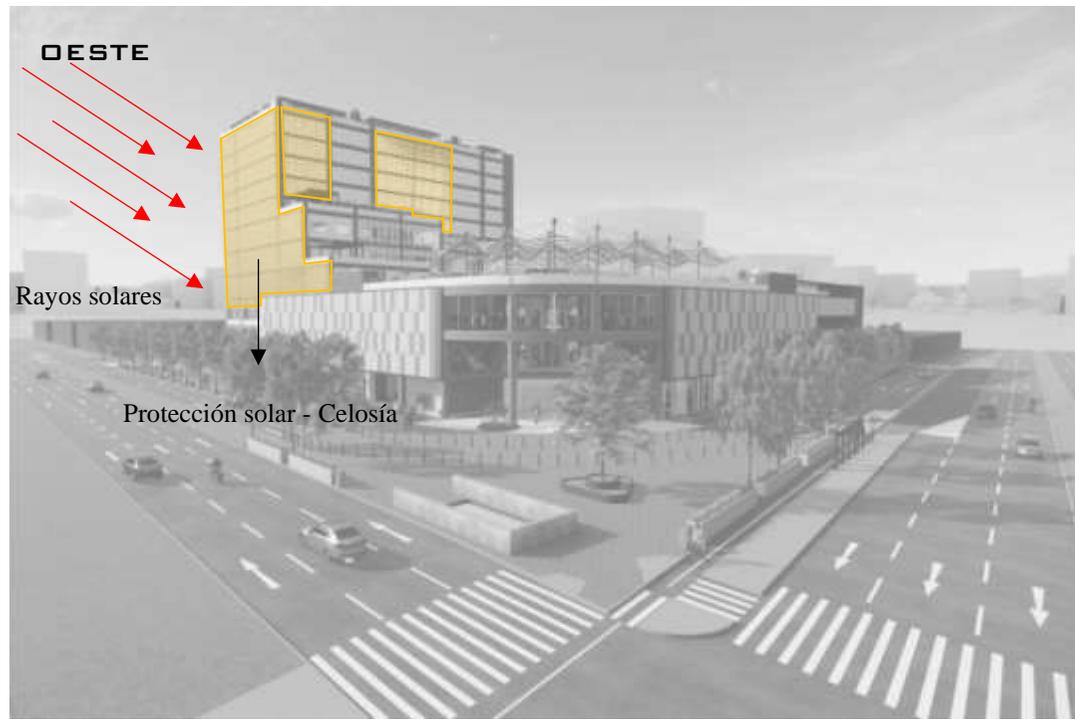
Aporte del proyecto – vista de las caras oeste - este
